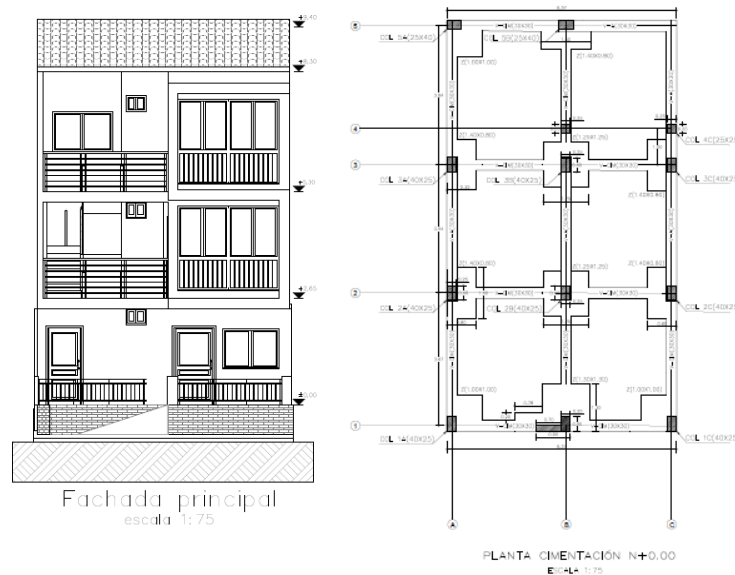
Edificio de 3 pisos, fachada frontal y cimentación.
